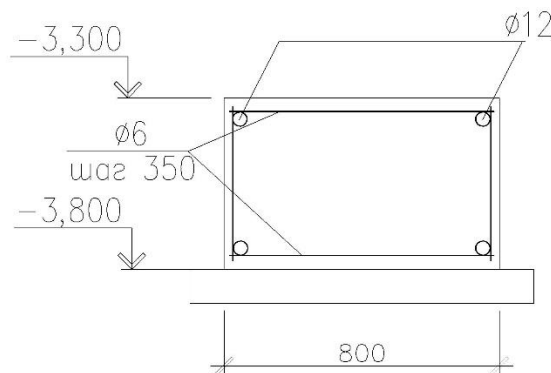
Схема армирования поперечного сечения ленточного фундамента
